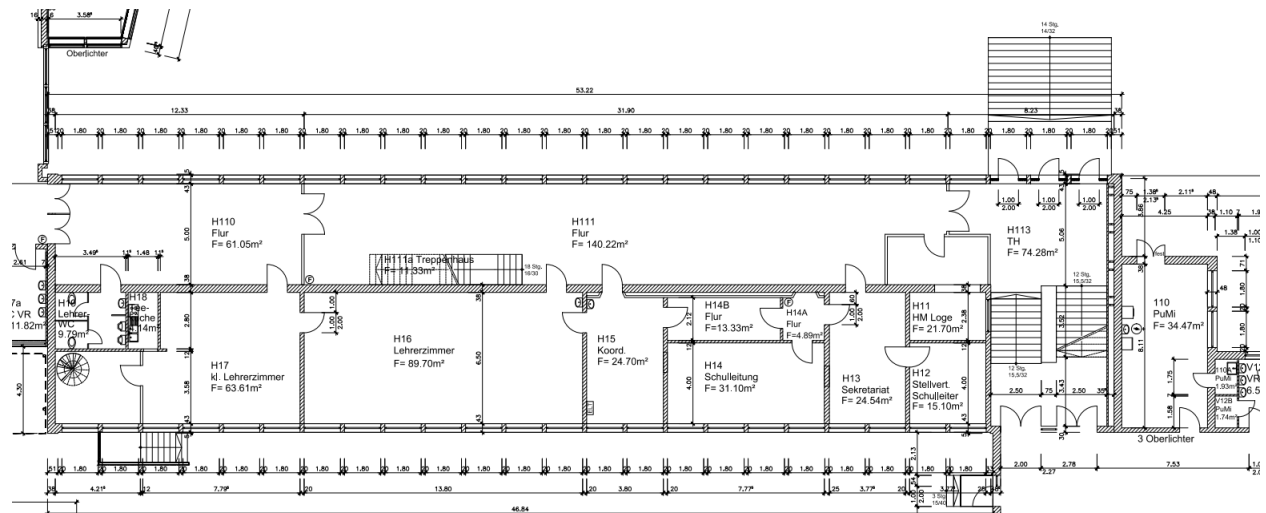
Grundriss Trakt H - Bestandsplan
